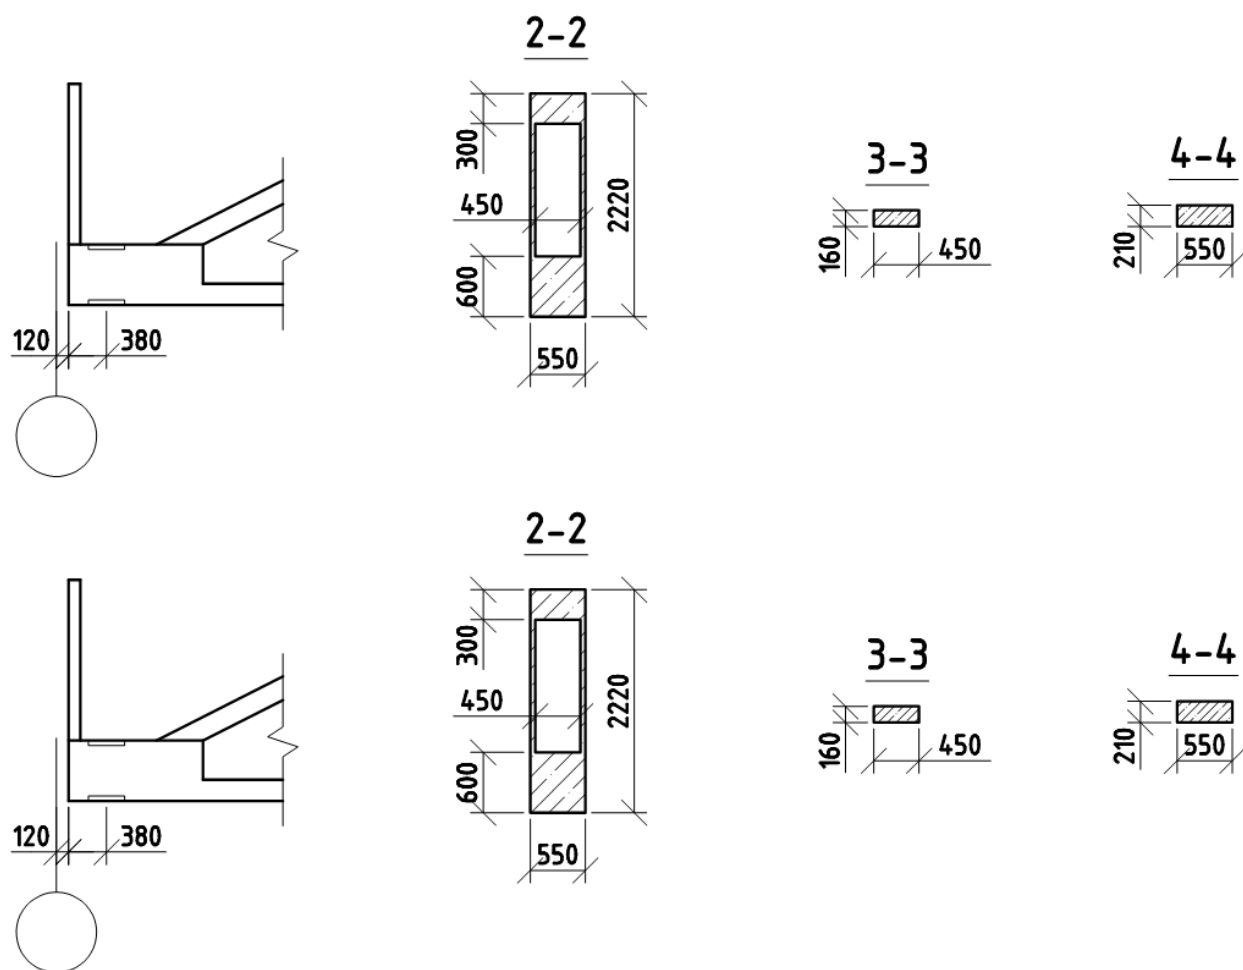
Подстропильные фермы для зданий со скатной кровлей.
